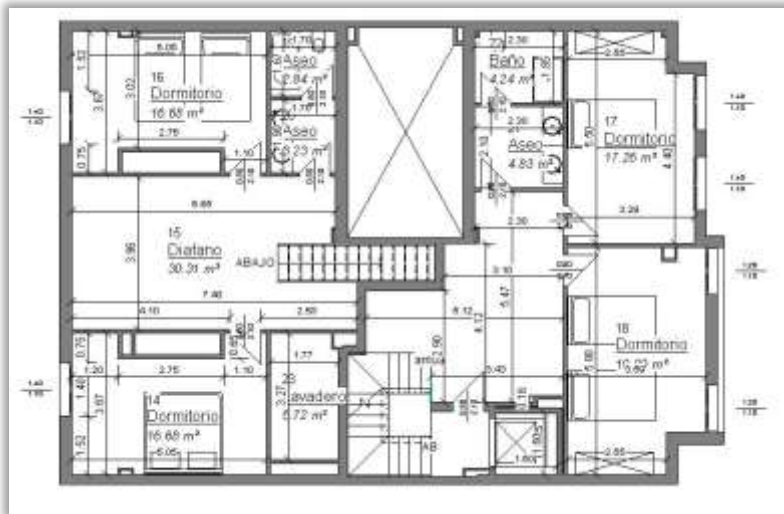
Ejemplo duplicación vista. Plano de cotas en LOD 200
